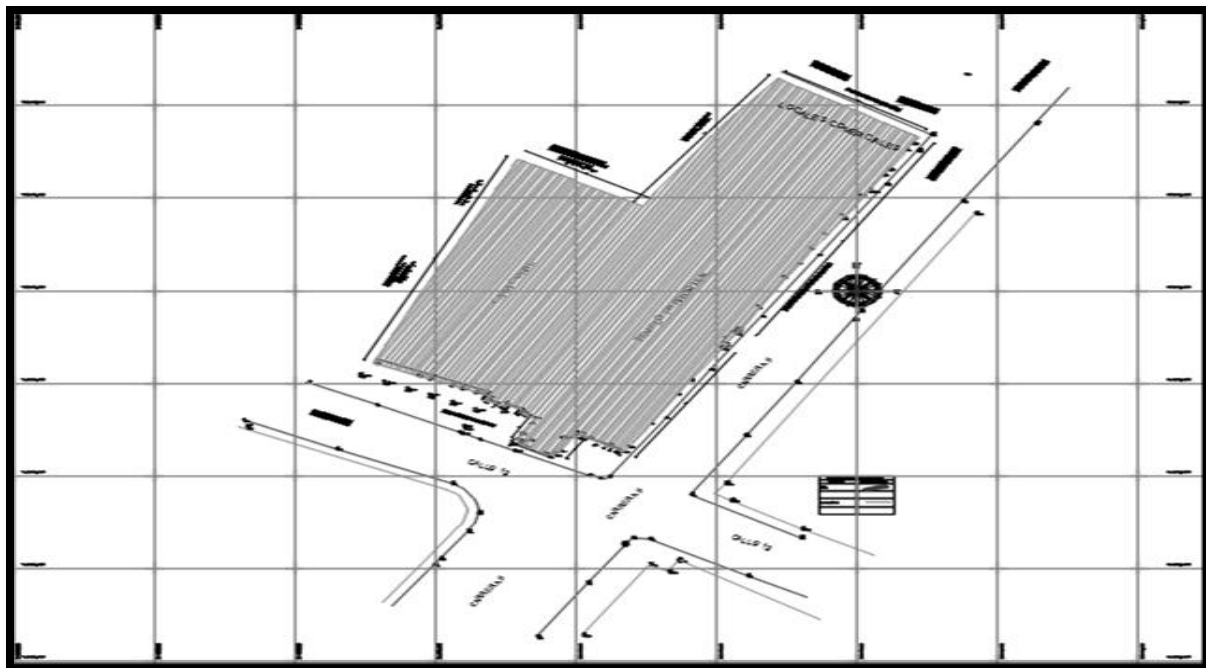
Levantamiento Topográfico Planta General Parroquia San Miguel, Girardot.
